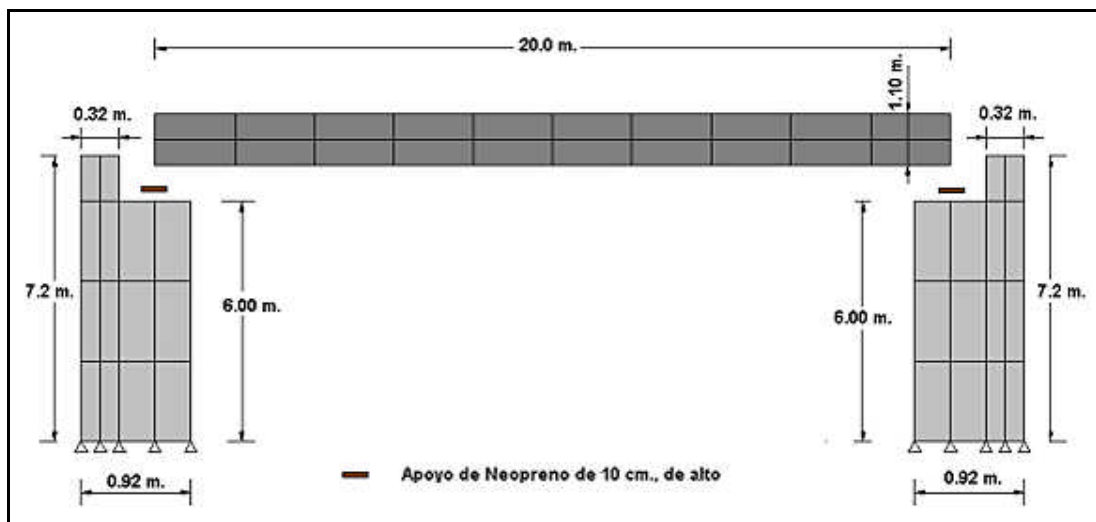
Puente conformado por dos estribos y vigas longitudinales.
